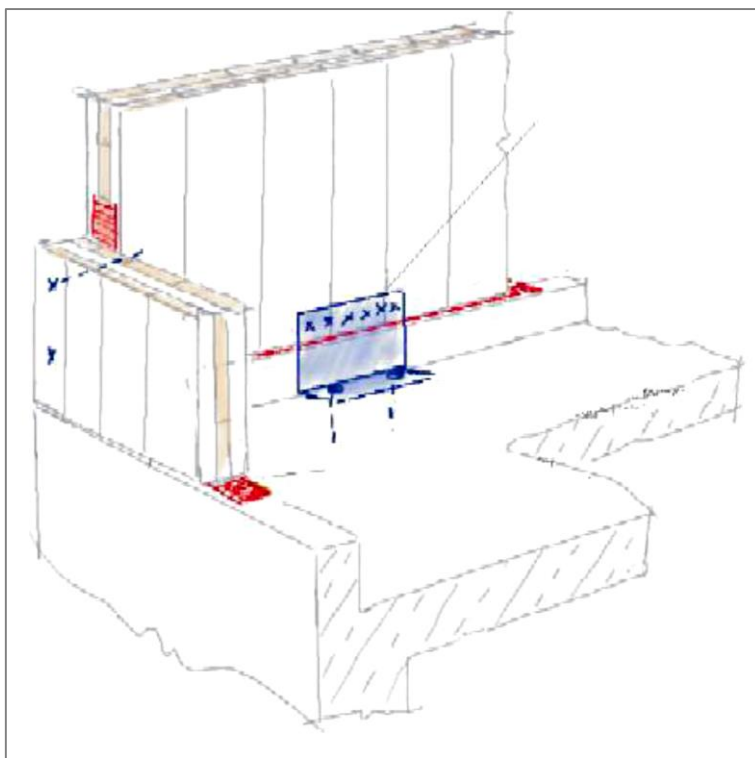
Ligações horizontais e verticais por ligadores metálicos (a azul) e por bandas de assentamento (a vermelho) de placas de CLT a fundações de betão
